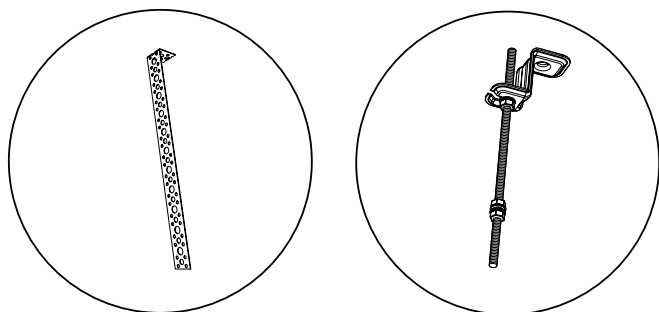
Монтажная планка и резьбовая шпилька (не поставляются)
